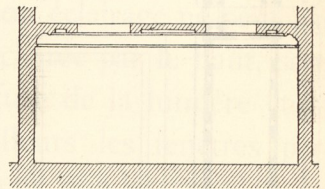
Vitrage en plafond d'une salle de grande largeur.
